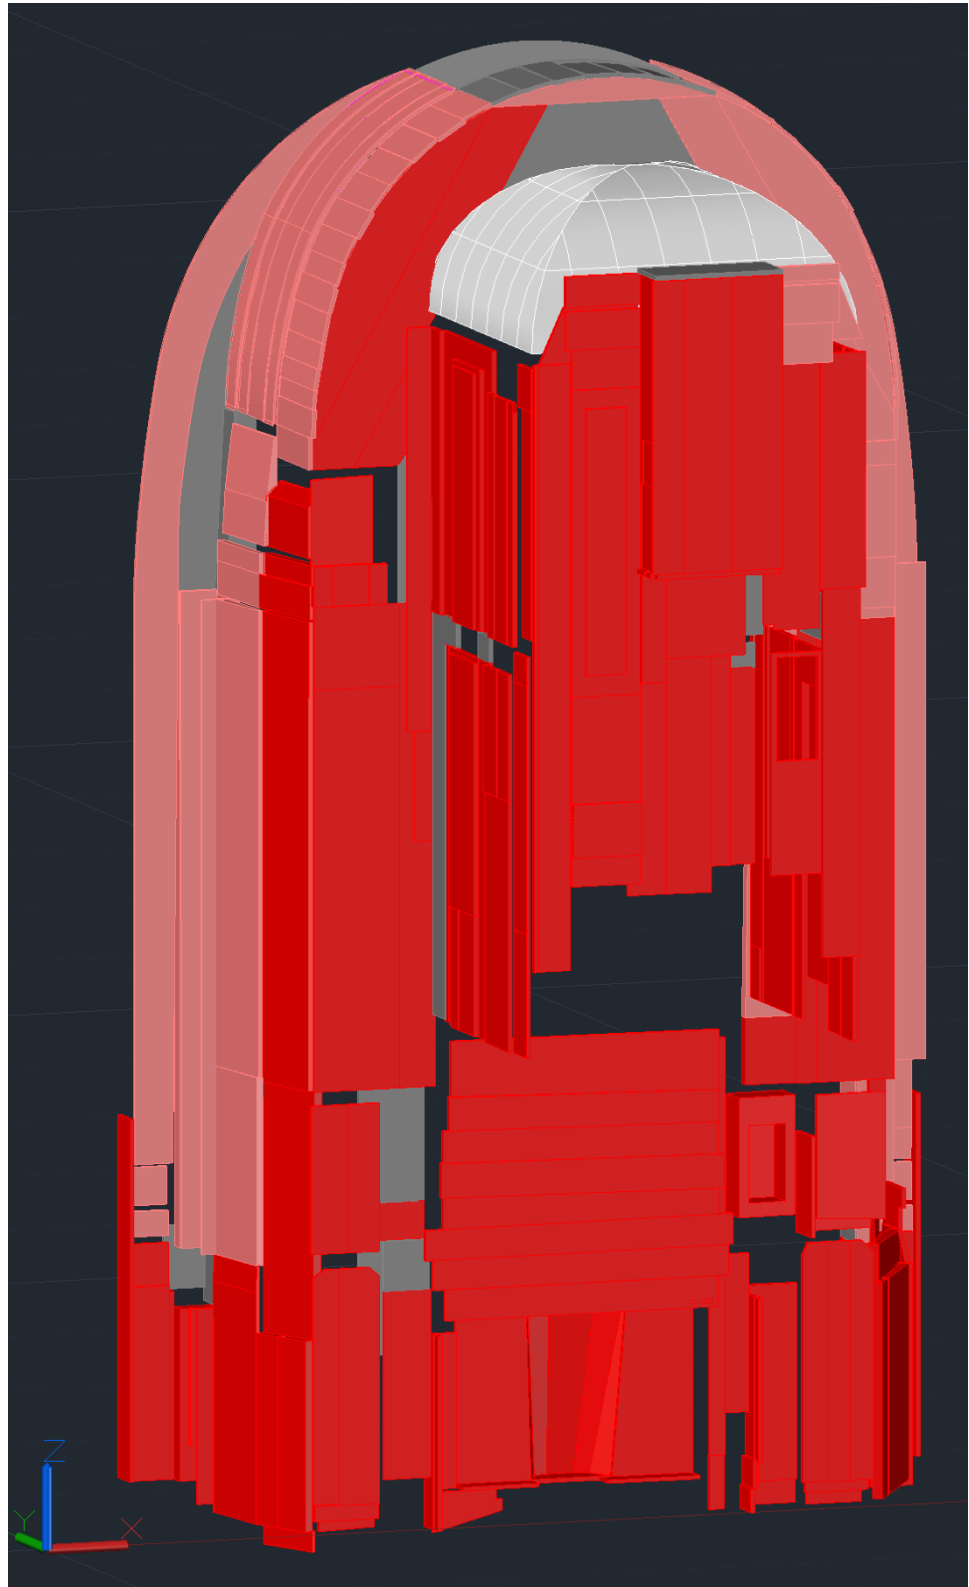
Desenho AutoCAD 3D - vista lado da Epistola
